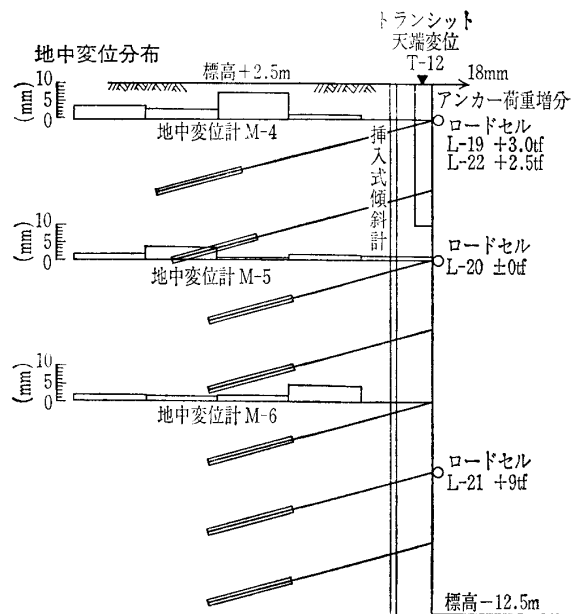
コンクリート吹付けアンカー部の計測断面、計測結果
